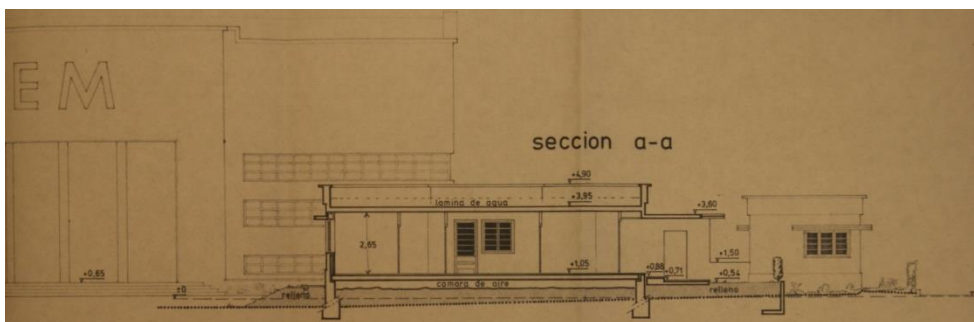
Sección del proyecto de vivienda para el portero. (AMV 1983b)
